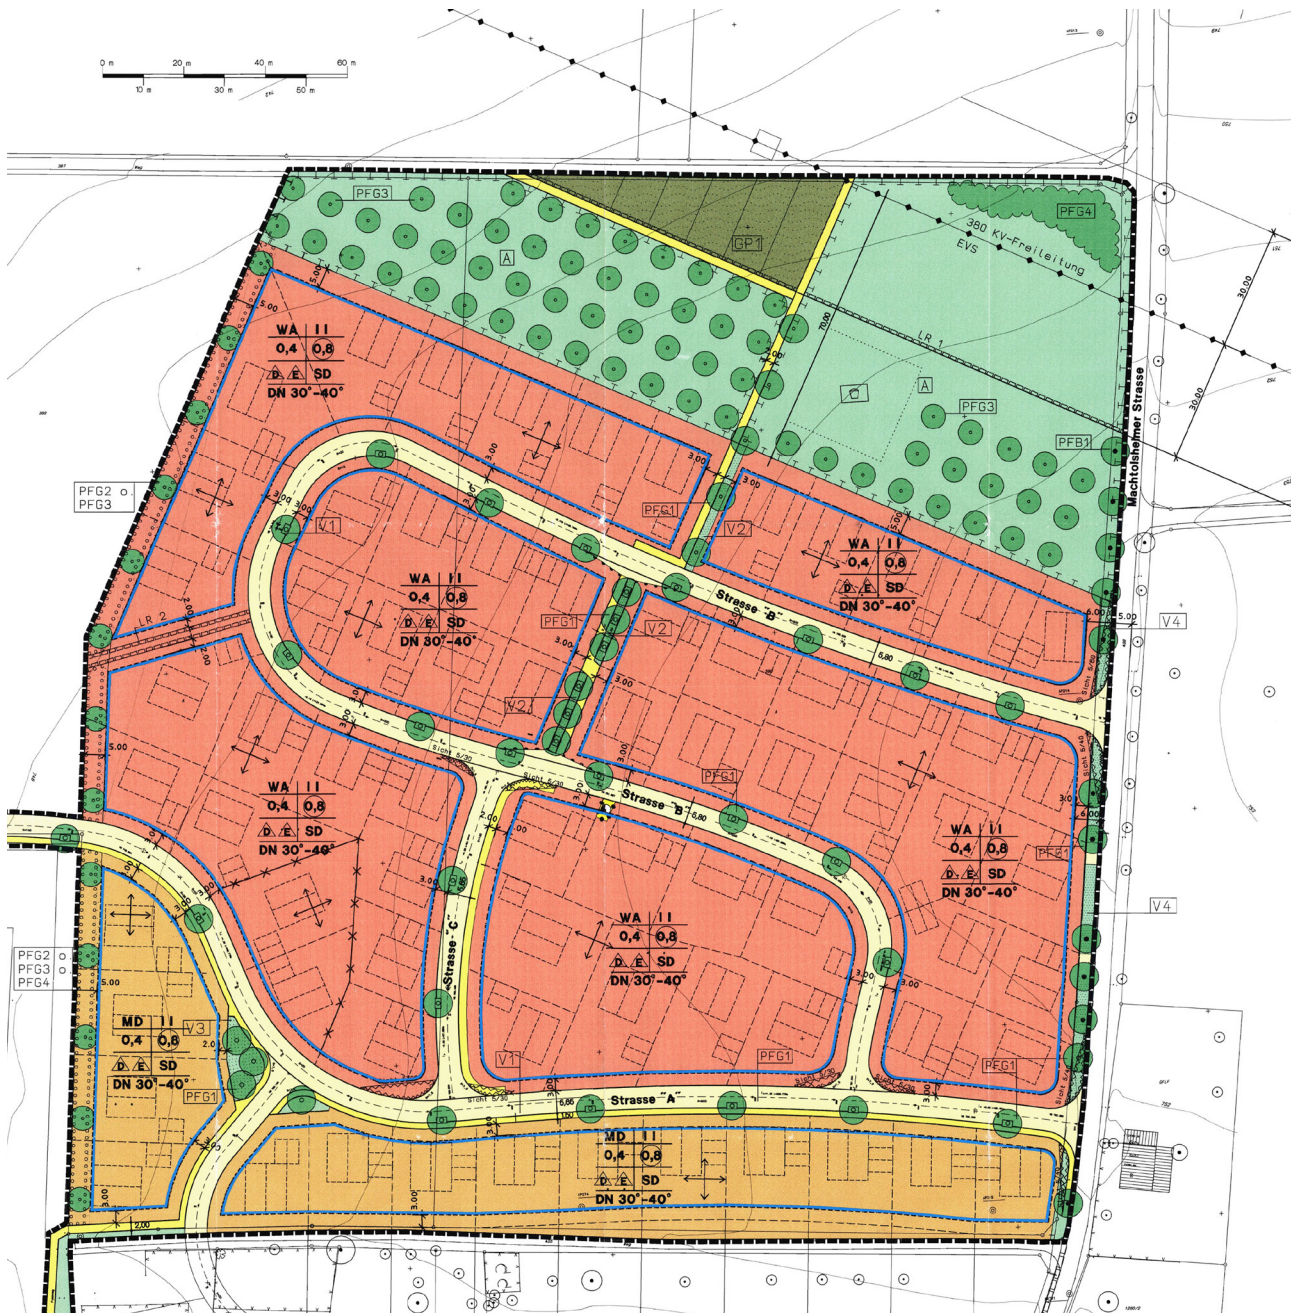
Bebauungsplan "In der Falge" mit der geplanten Erweiterung der Wohnbebauung
